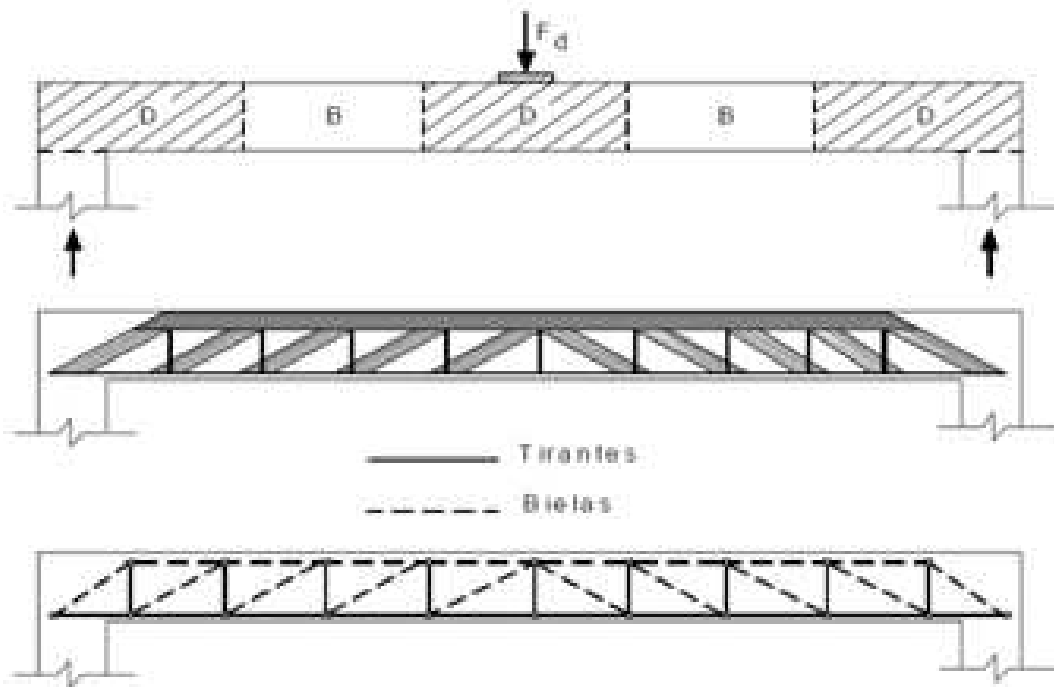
Modelo de treliça para uma viga em concreto armado.
